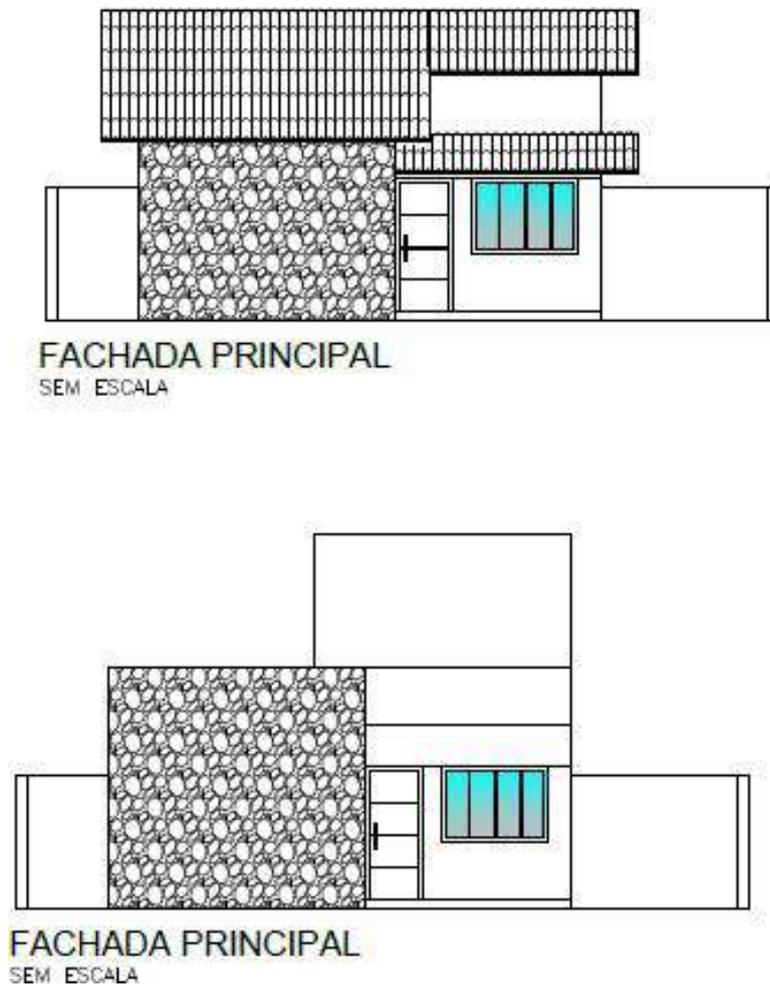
Layout* Projeto com telhado aparente (sem escala).
